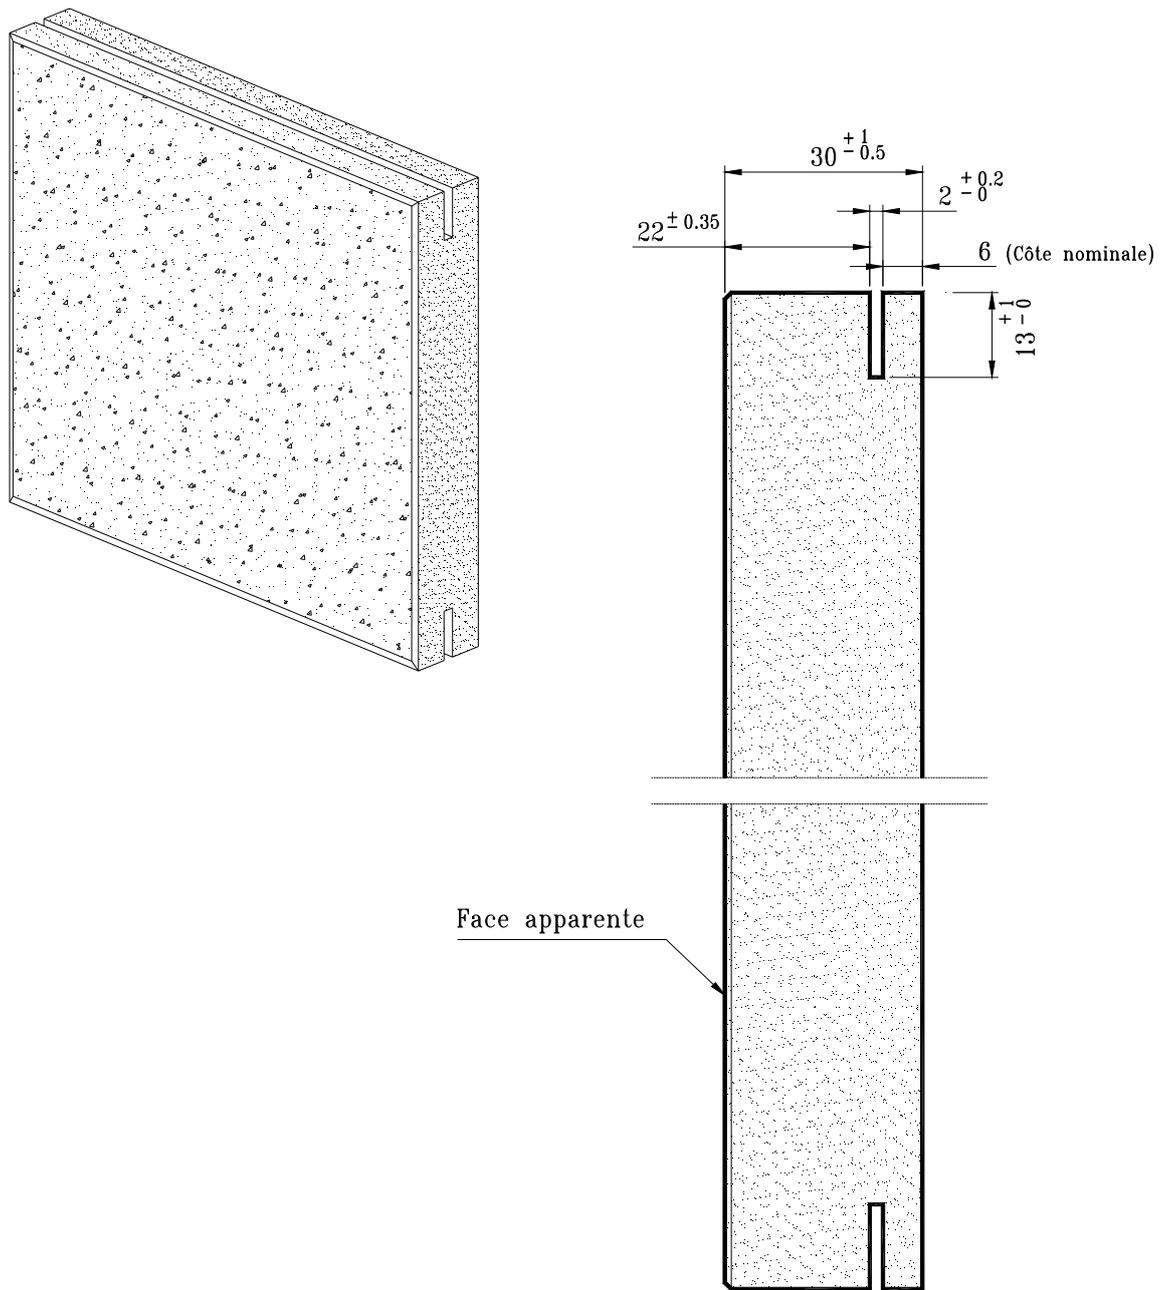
VETIRAIL CRISTO 30 mm - SB (soubassement)
